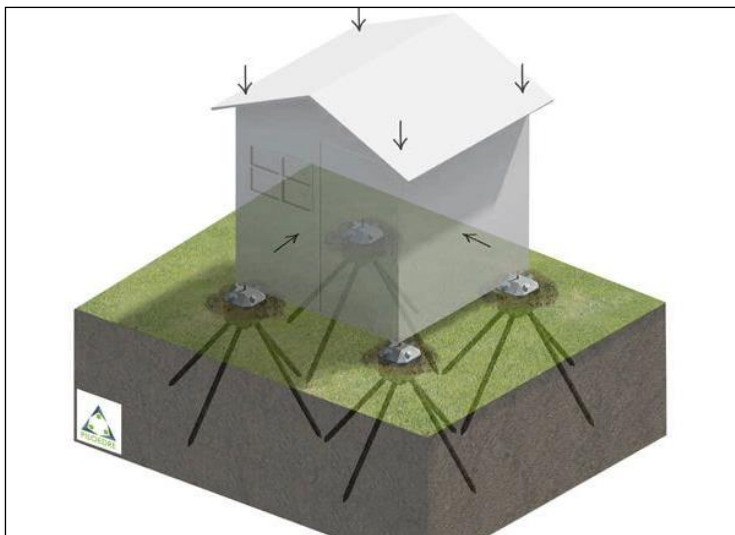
Vivienda modular prefabricada soportada por Pilodres como cimentación superficial
